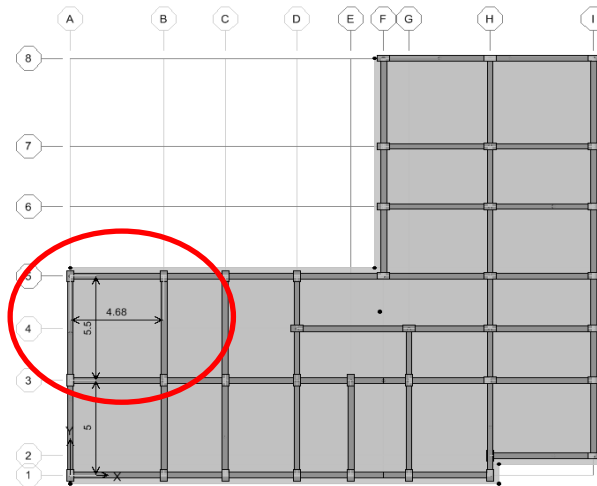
Panneaux de dalle du radier (e = 45cm)
